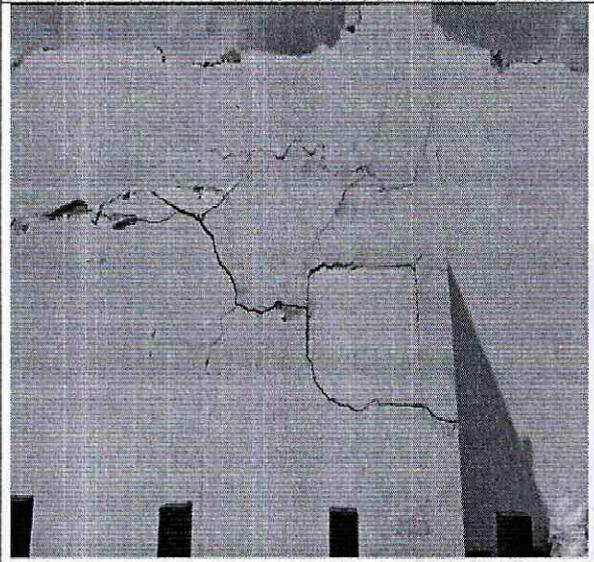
Grietas y fisuras en muro, daño severo.
